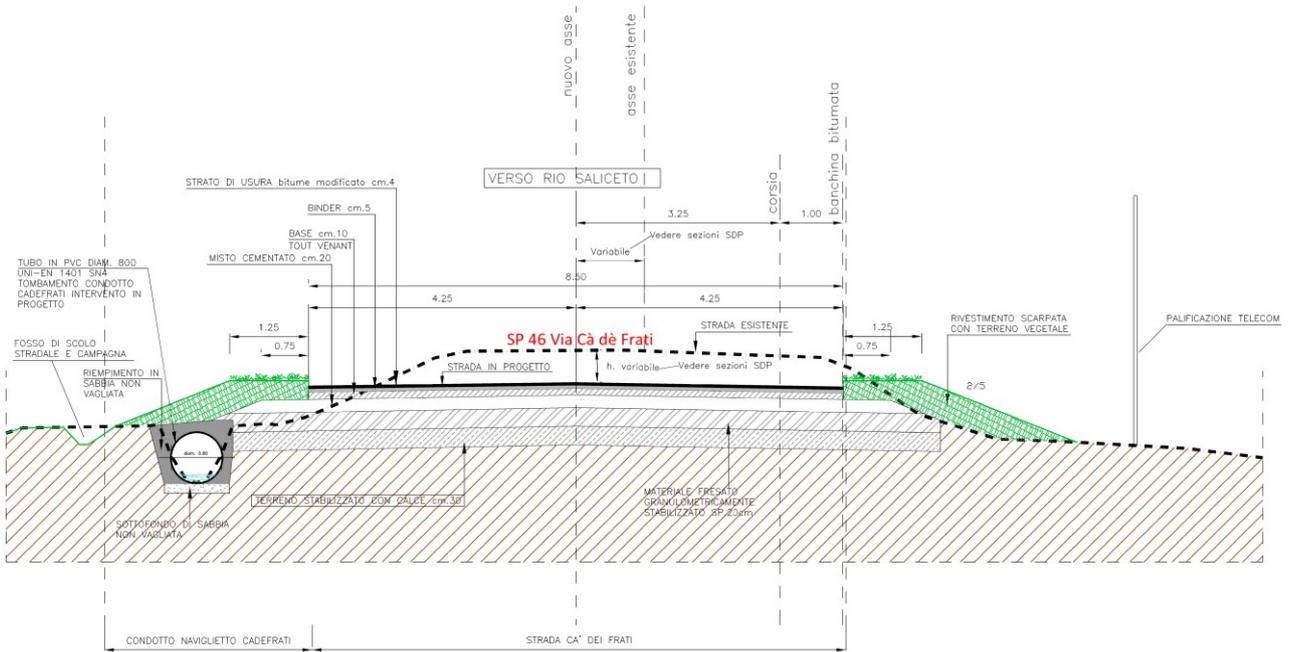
Sezione tipologica di progetto (lato Rolo)
